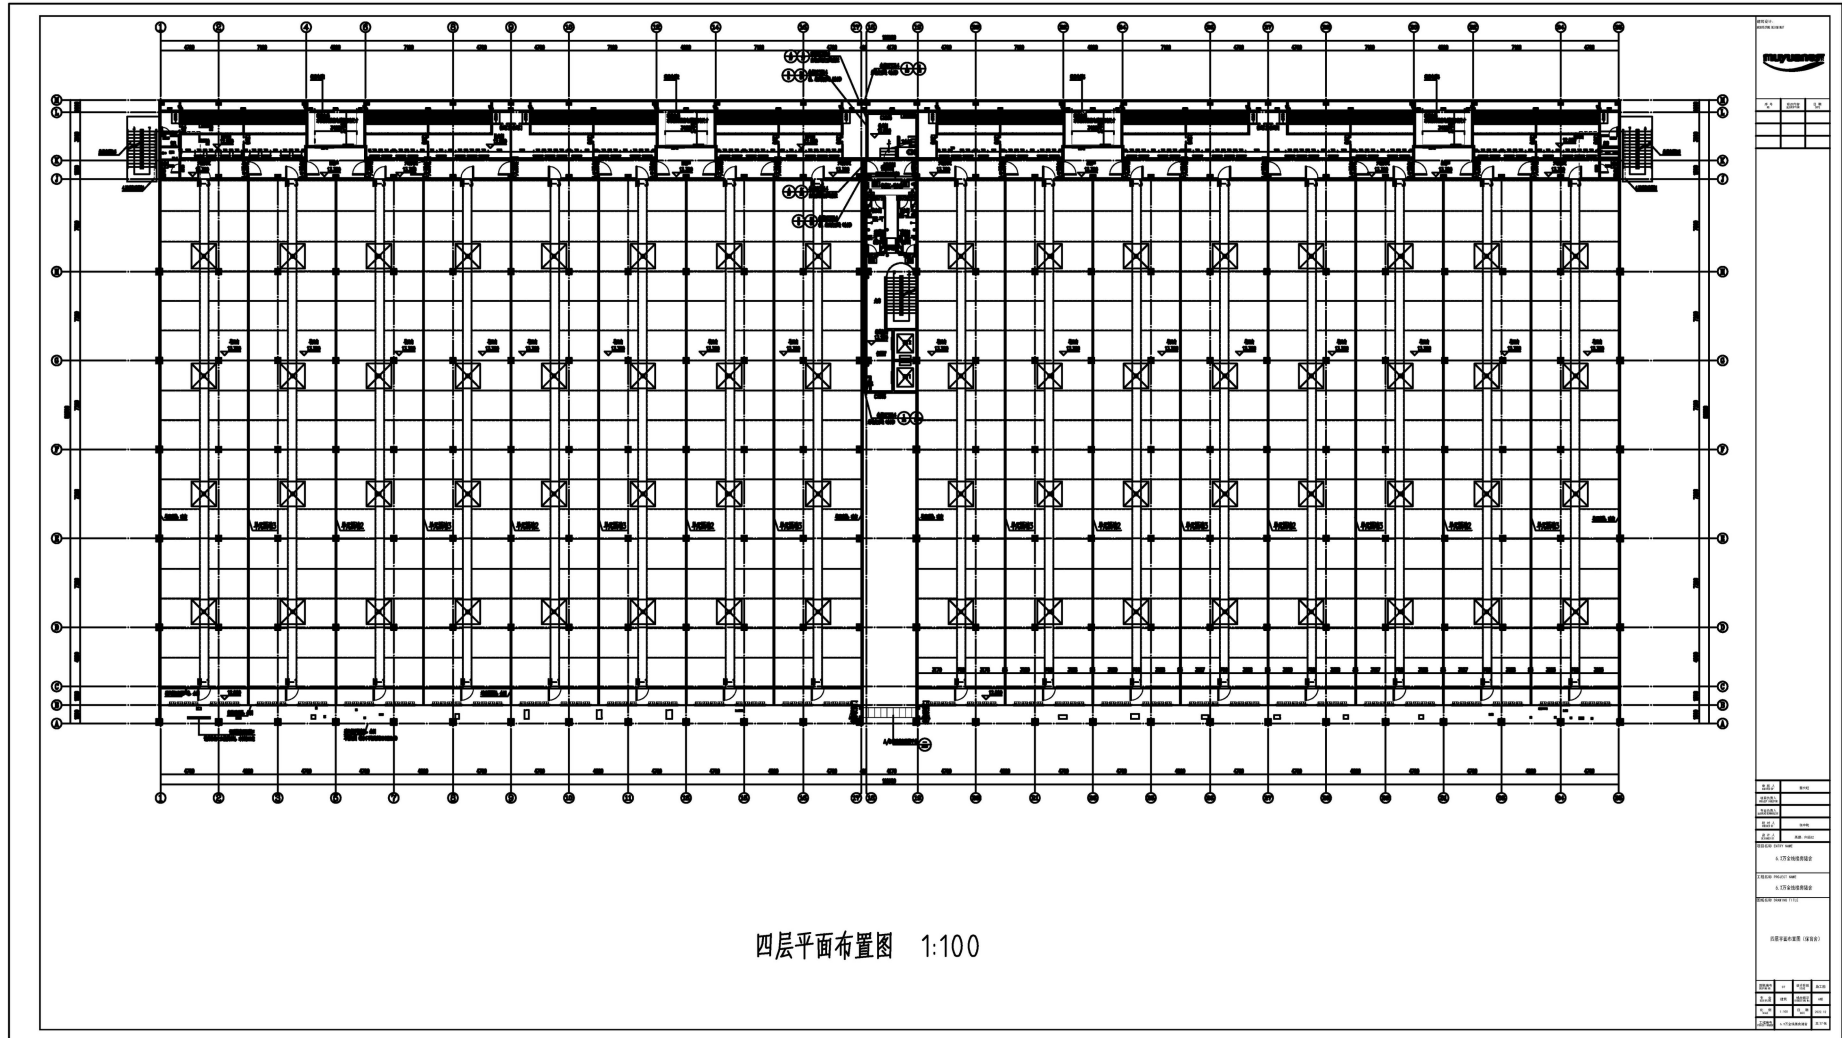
楼房猪舍（4层）平面布置示意图
